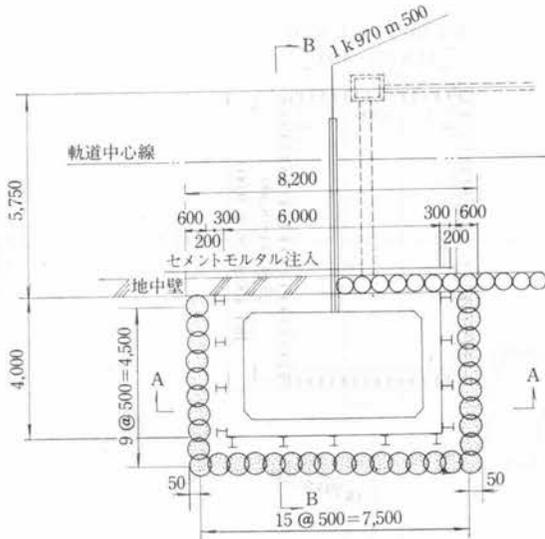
(a) 生麦トンネルポンプ室 JST 注入工事平面図
